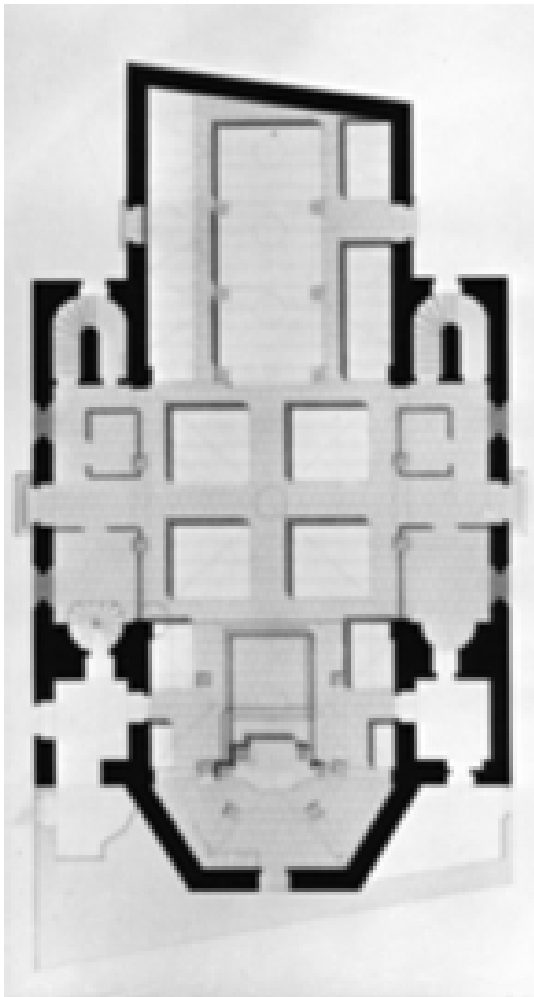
Grundriss der Lutherischen Stadtkirche um 1823
